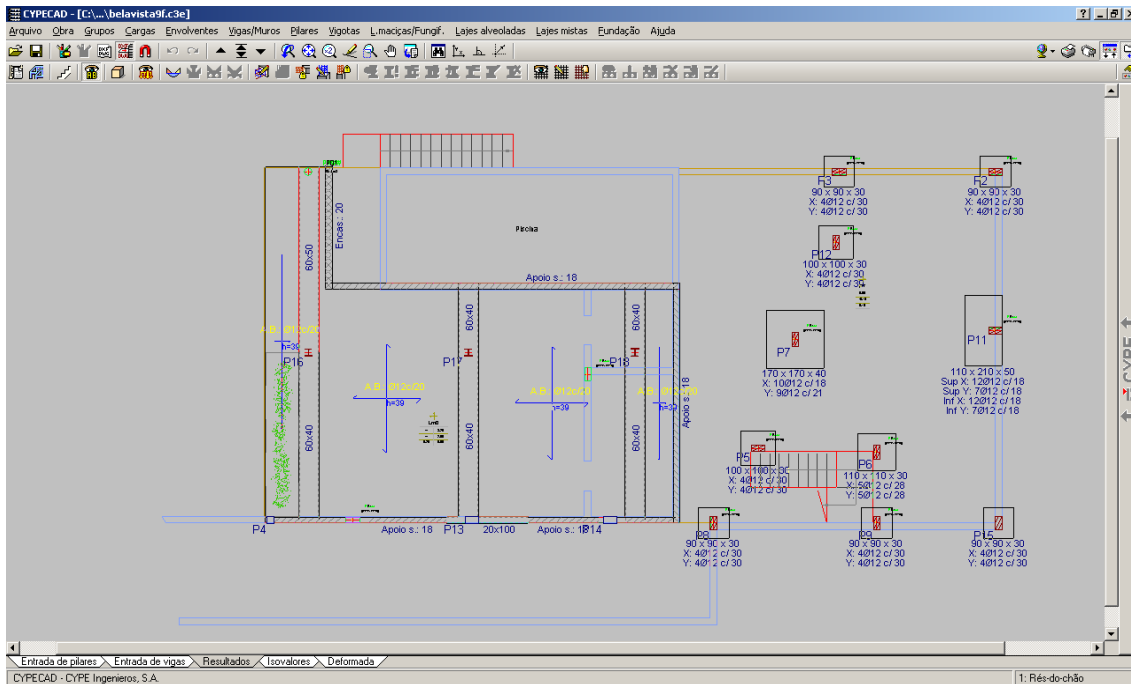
ARMADURAS NAS SAPATAS (CYPE)
